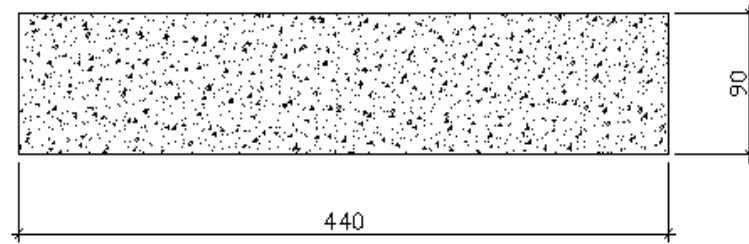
geometria da base dos pilares centrais (unidade em cm)
